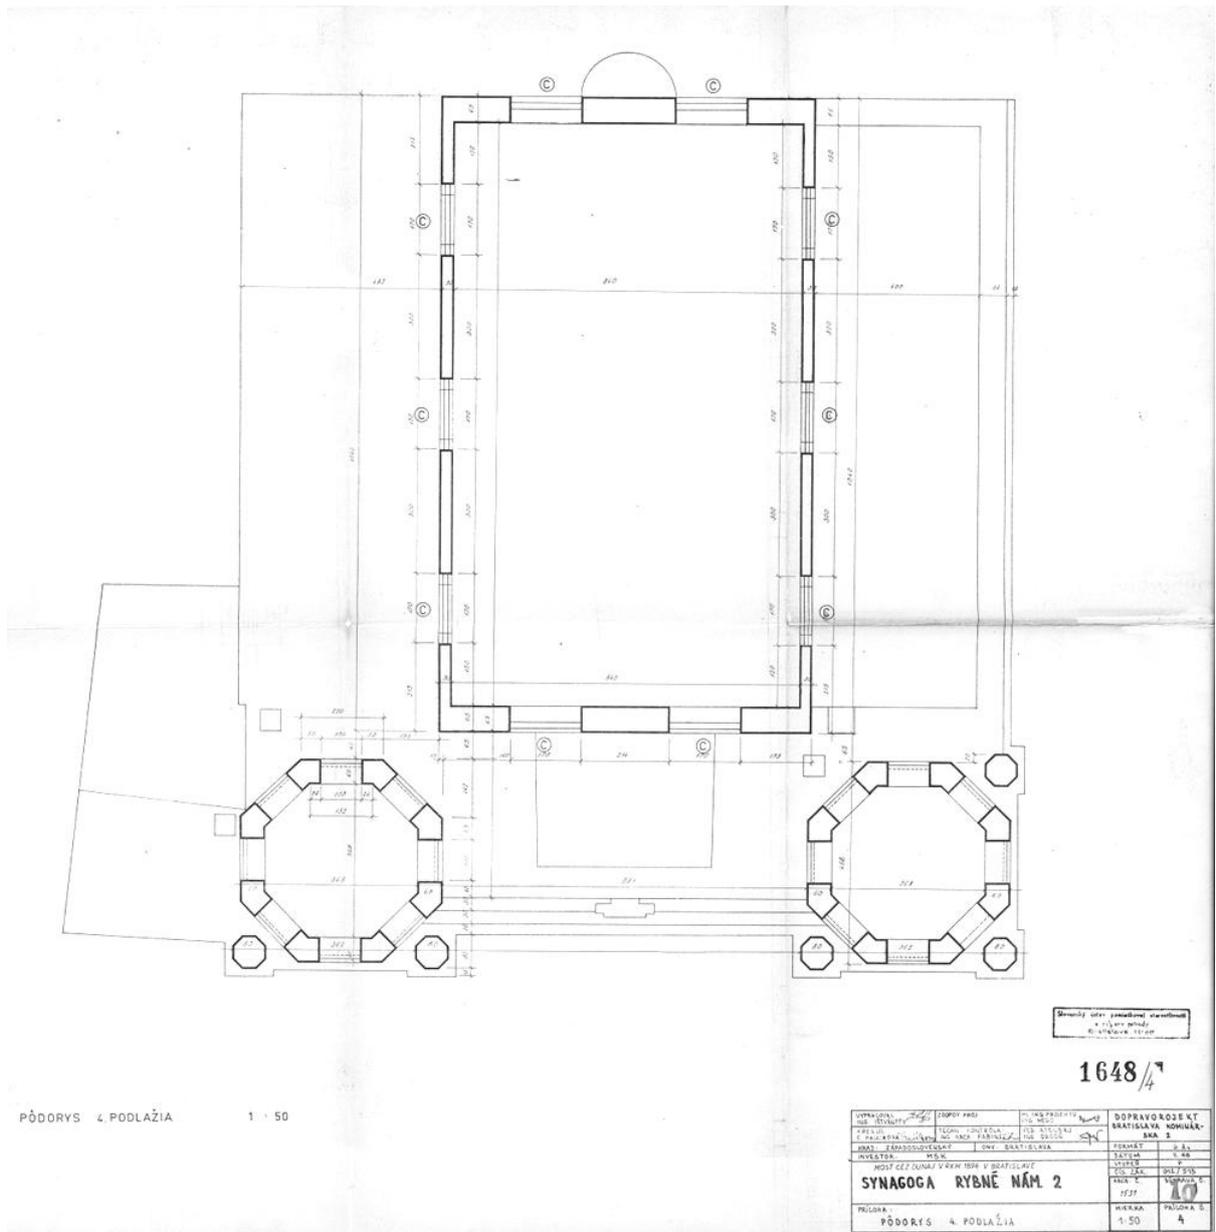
Grundriss 3. Obergeschoss M 1:50, 1967
